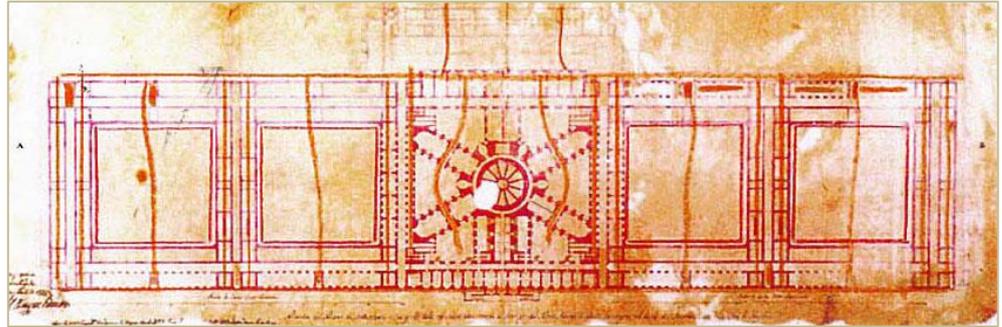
Albergo dei poveri, pianta piano interrato. Archivio di Stato di Napoli, piante e disegni, 1753
